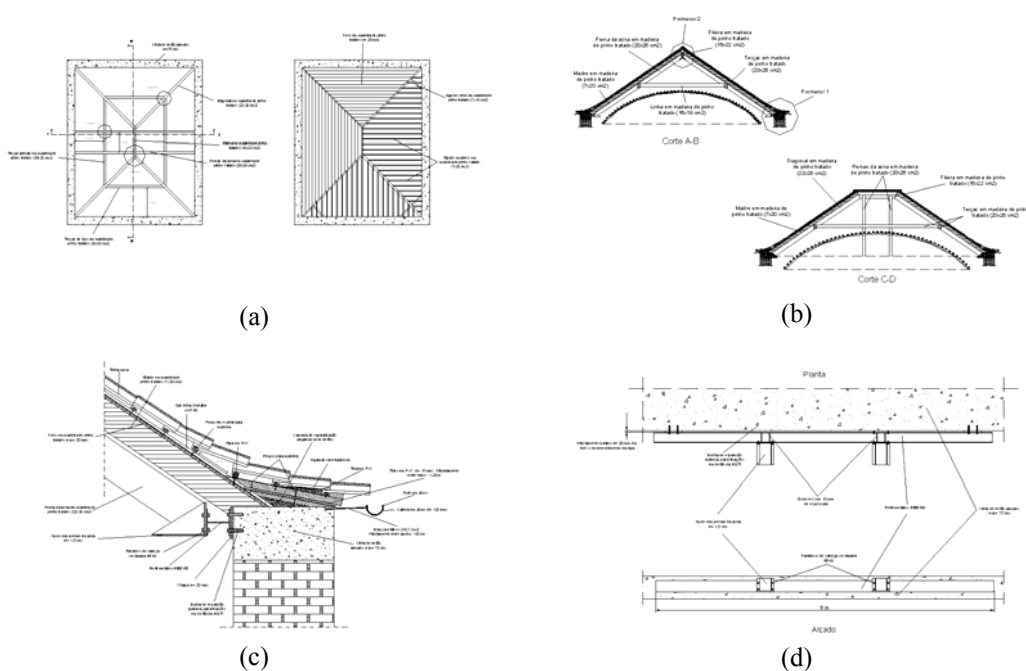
(a) estrutura da cobertura (planta, forro e ripado); (b) cortes AB e CD; (c) pormenor do apoio da asna central; (d) viga metálica para apoio das asnas centrais.
